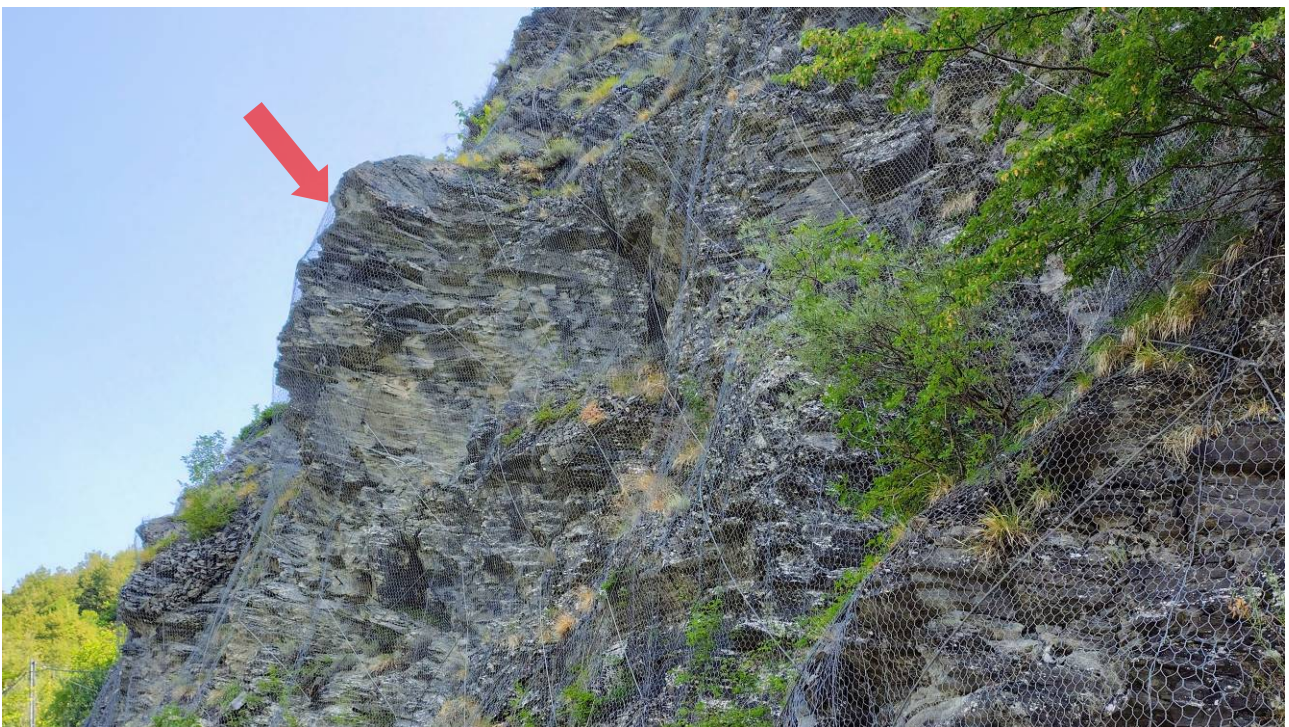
Particolare della parete rocciosa sovrastante la SP 15 con evidenziato il “pilastro” di roccia da demolire parzialmente e oggetto del consolidamento con chiodatura e posa di pannelli in fune.
